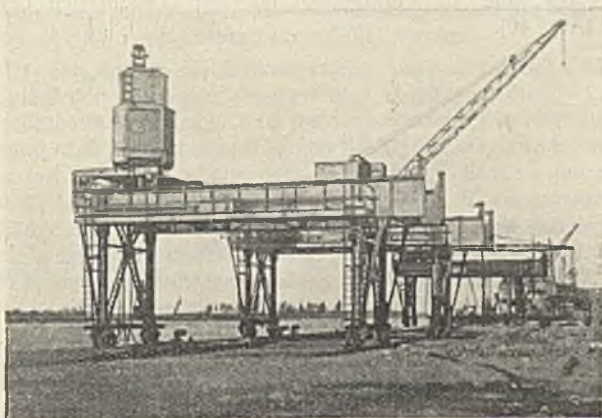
Bordeaux. Volltorkrane in Bassens Aval im Bau.
